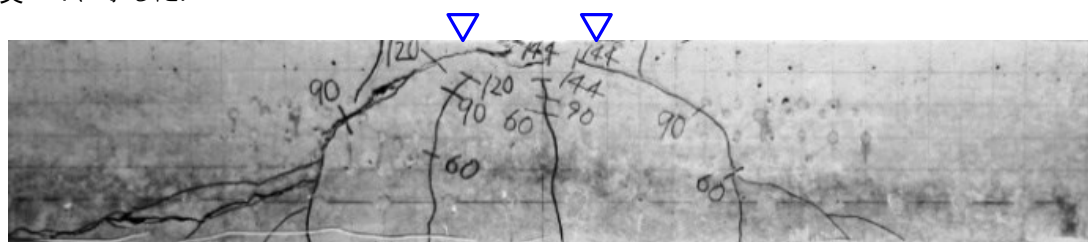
膨張 Ps0.8%-250B ひび割れ状況（せん断-曲げ圧縮破壊例）
